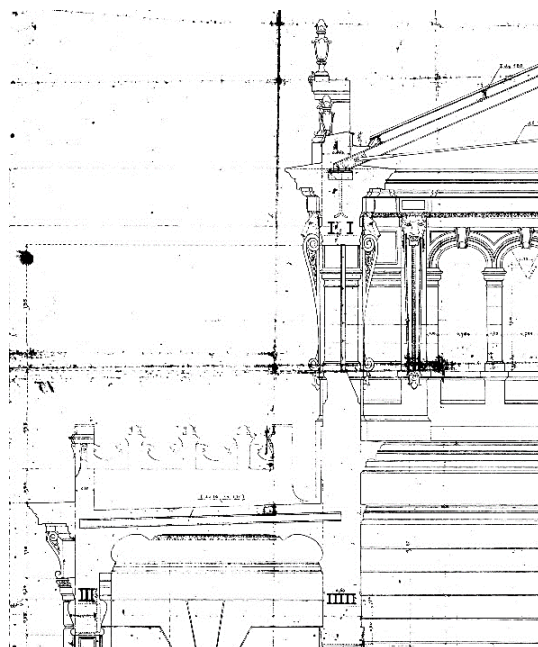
Detalle constructivo con los refuerzos de perfiles de acero. Plano N° 15 DNOA
